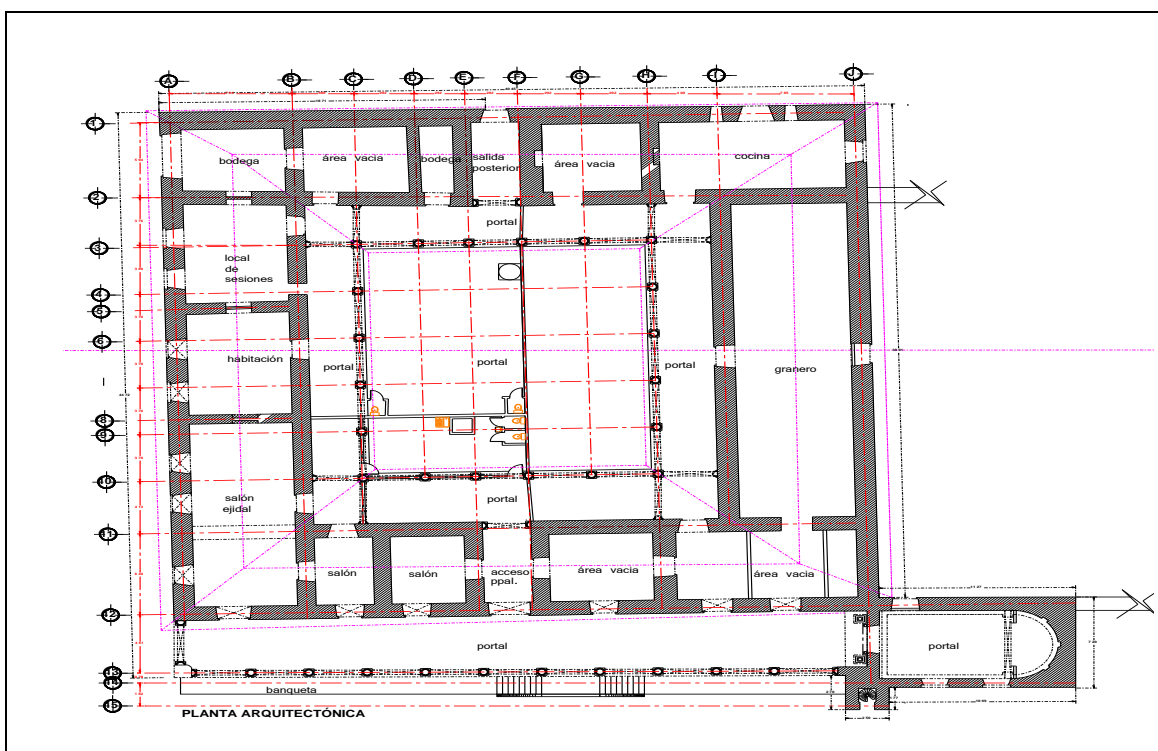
Planta arquitectónica de la casa del hacendado.
